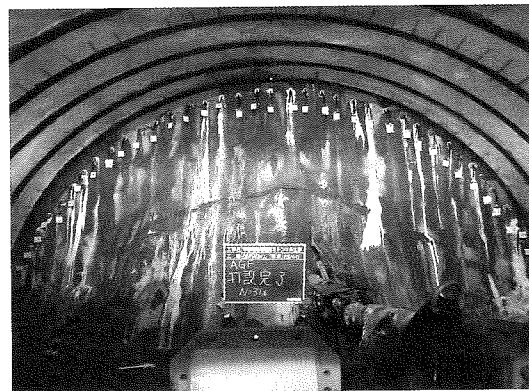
長尺鋼管施工状況(パターン3)<sup>2)</sup>
